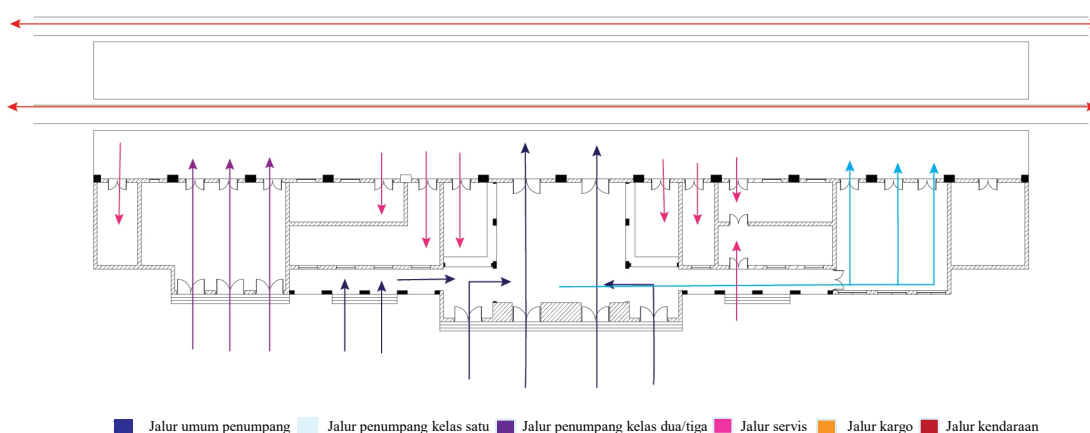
Sirkulasi Ruang Stasiun Tawang
